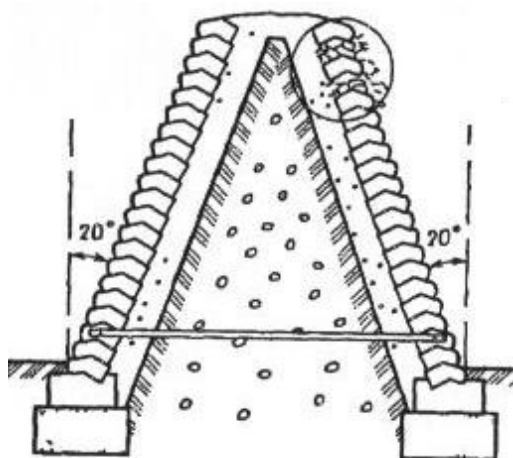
Поперечный разрез шумозащитного экрана из бетонных блоков с земляным валом
